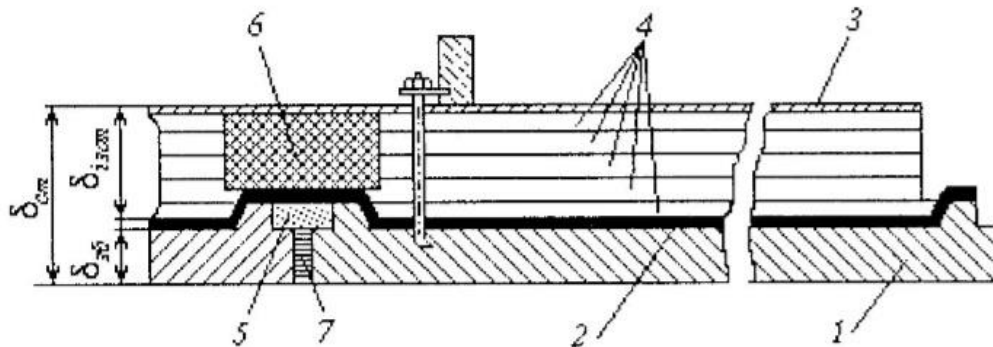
Конструкція збірних стінових вертикальних ізолюваних панелей багатопверхових холодильників і кріплення до між етажного залізобетонного перекриття (вид зверху): 1 – залізобетонна плита; 2 – пароізоляція (холодна бітумна ґрунтовка і шар пластифіцированого боруліна на гарячій бітумній мастиці); 3 – азбоцементний пресований лист ($\delta_a = 8$ мм); 4 – мінеральна пробка загальною товщиною 300 мм; 5 – бетон; 6 – більш ефективний, чим основний, теплоізоляційний матеріал; 7 – закладення шва цементним розчином.
